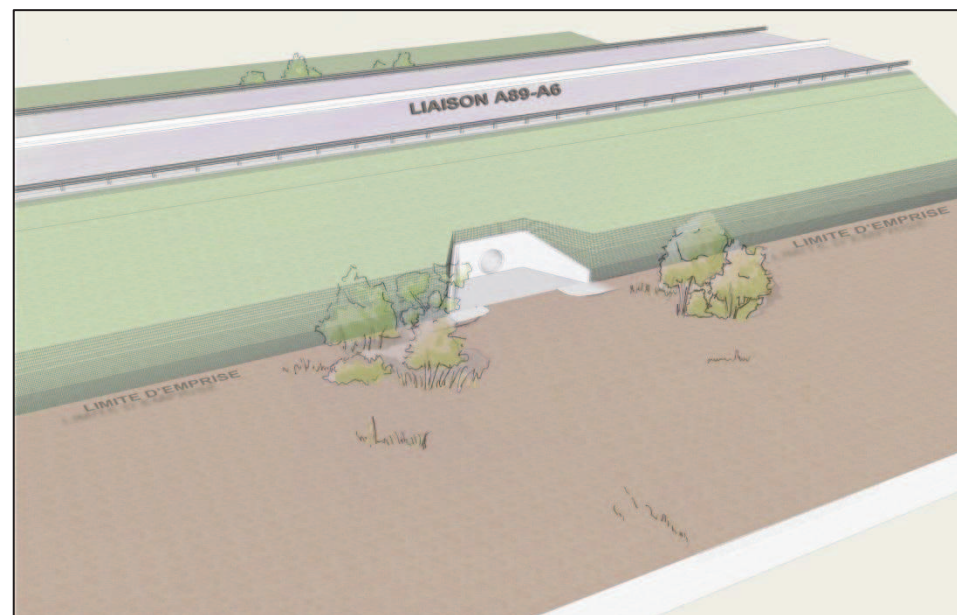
Exemple d'aménagement autour d'un ouvrage hydraulique
